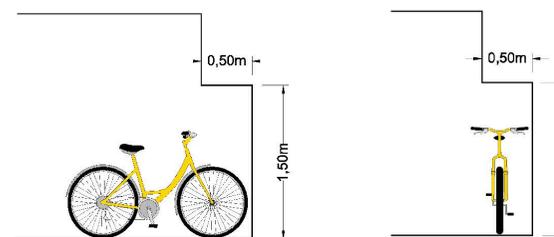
Gabarit du fond de l'emplacement (vue en élévation)
